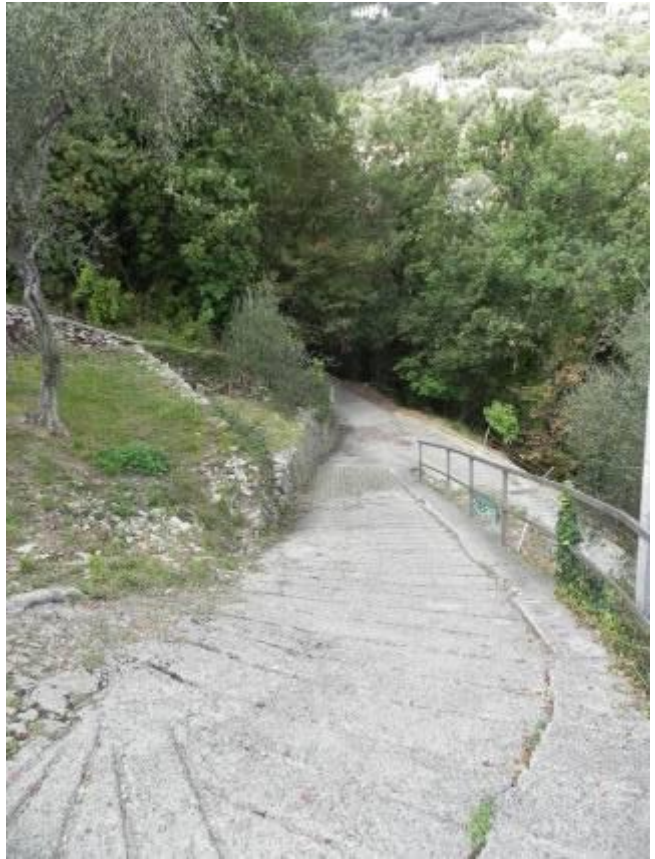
a 54 – Viste della strada vicinale che dà accesso alla proprietà
